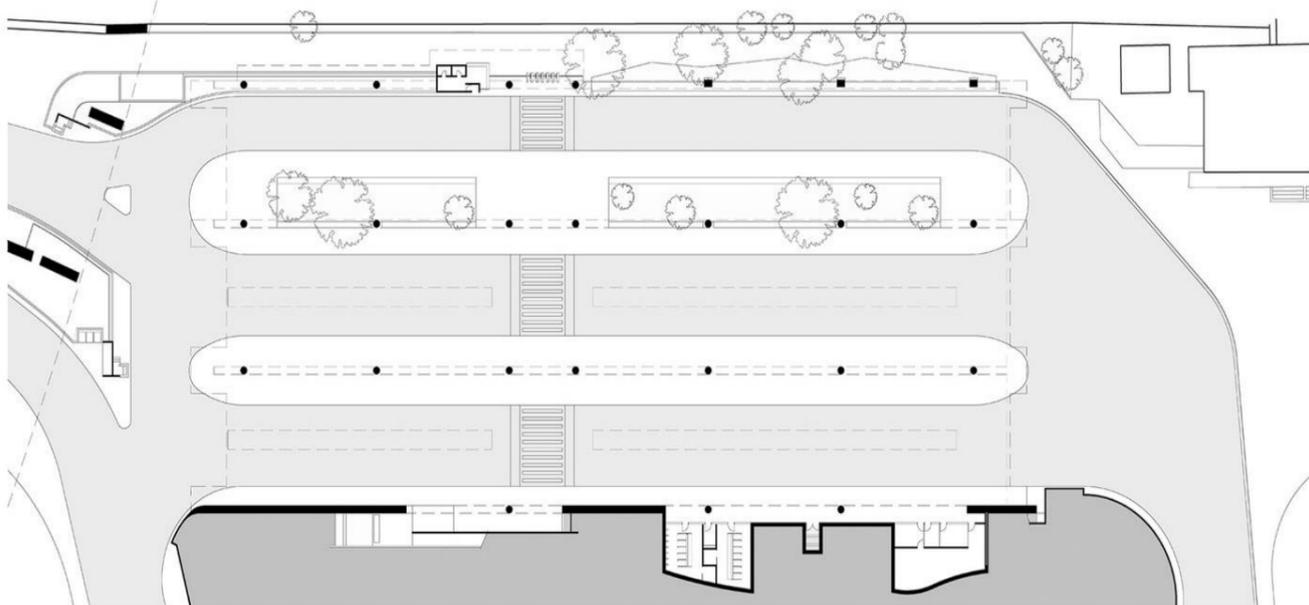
IMPLANTAÇÃO. FONTE: ARCHDAILY.
